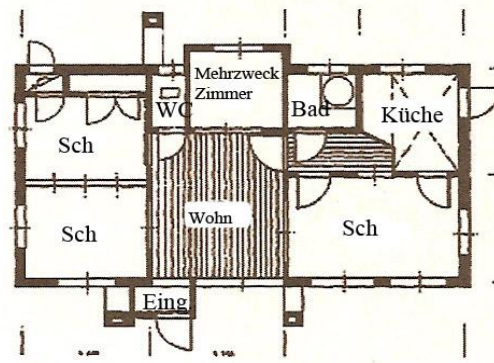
Grundriss einer späteren Young-Dan-Wohnung
